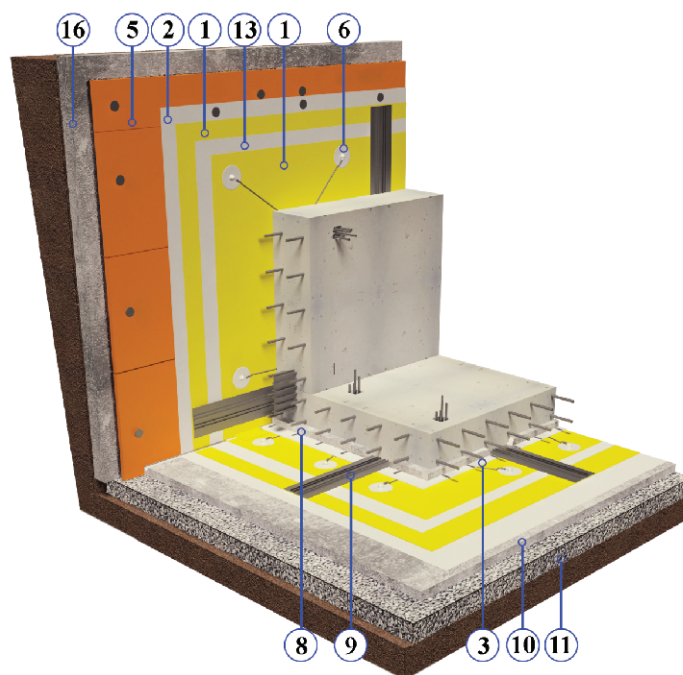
Схема двухслойной гидроизоляционной системы при открытом способе строительства без пазух под обратную засыпку. 1-Гидроизоляция PLASTFOIL®; 2-защитный слой; 3-геотекстиль 500; 5-ПЕНОПЛЭКС®; 6-контрольно-инъекционная система; 8-защитная стяжка; 9-гидрошпонка; 10-бетонная подготовка; 11-щебеночная подготовка; 13-геотекстиль 150; 16-ограждающая конструкция.
